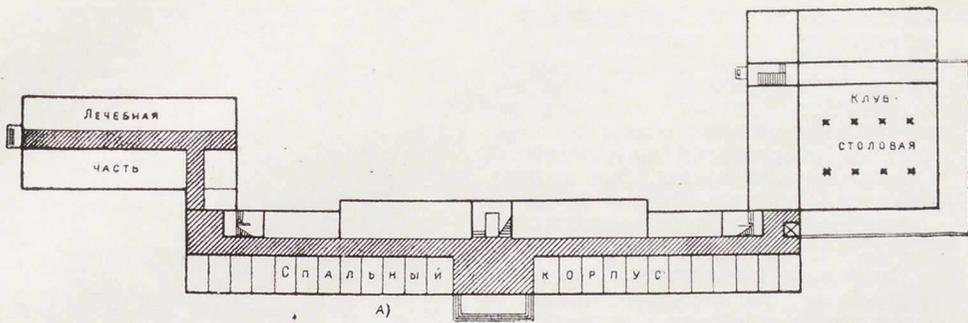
Типовой лечебный корпус для санаториев на 250 мест
